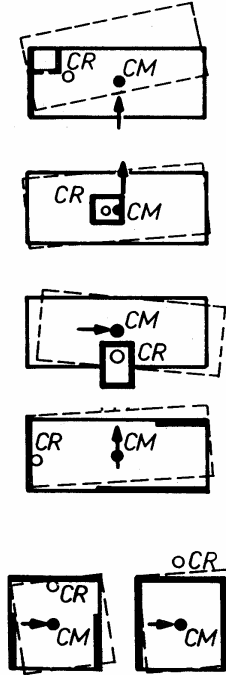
Distribución asimétrica de muros en planta (Paulay y Priestley, 1992)
